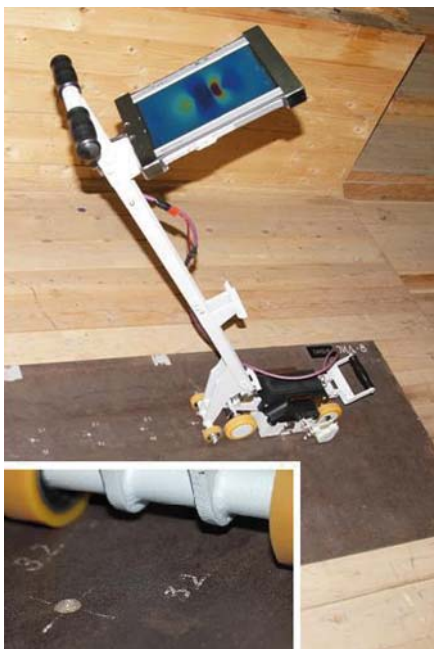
Калибровка магнитного дефектоскопа ИНТРОКОР с помощью контрольного образца участка днища стального резервуара
